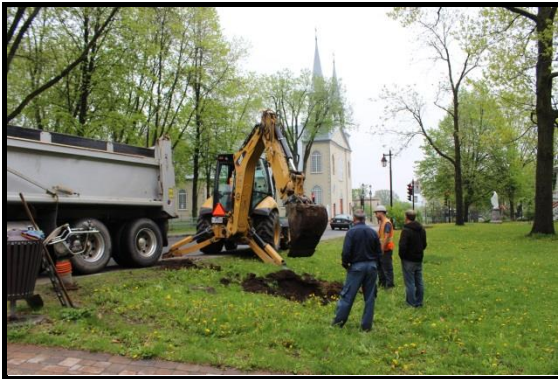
Vue générale du sondage CfEt-7-13G en cours d'excavation, vers le sud-est (Photo : Manon Goyette, Ville de Québec).
